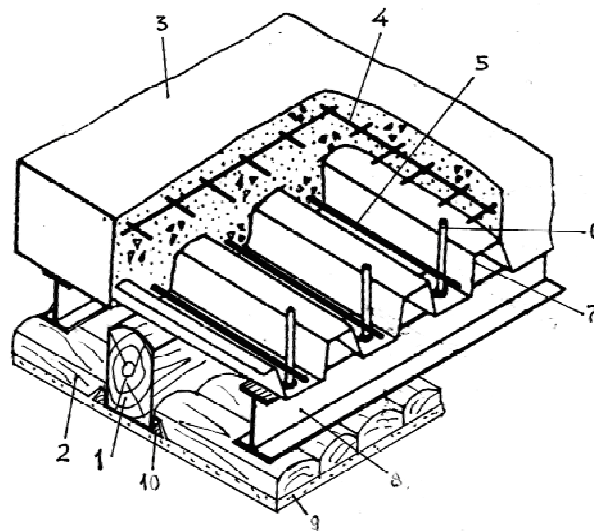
Конструктивная схема замены деревянного перекрытия на монолитное железобетонное по стальным балкам: 1 – существующая деревянная балка; 2 – накат; 3 – монолитная железобетонная плита; 4 – арматурная сетка; 5 – рабочая арматура; 6 – вертикальные анкеры; 7 – профилированный стальной лист; 8 – стальная несущая балка; 9 – штукатурка потолка.
